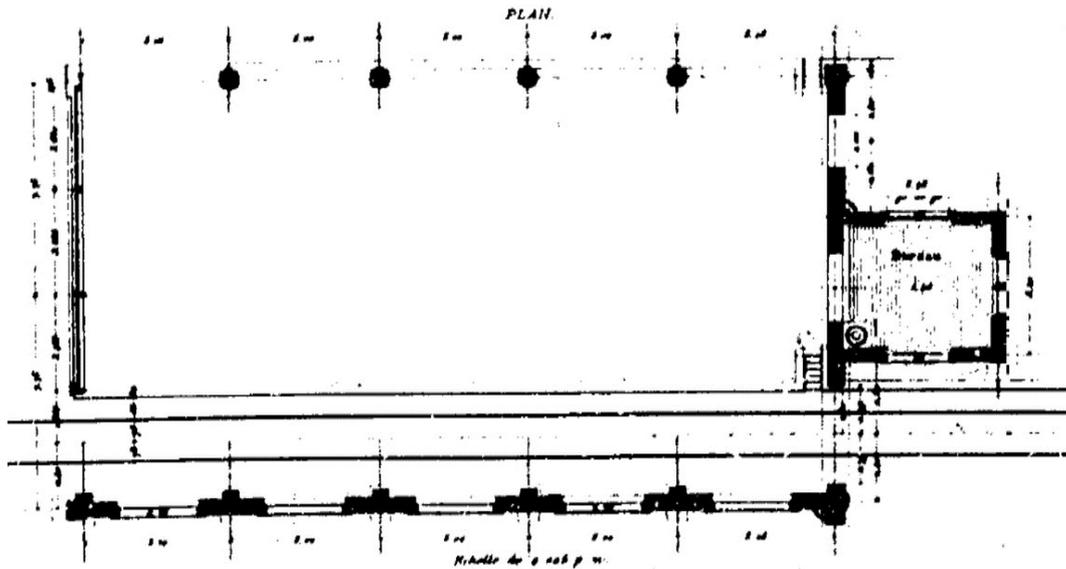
Pianta della Halle Marchandise de la Gare de St. Amand. Fonte: blog di collezionista privato, Jean-Claude Drion
